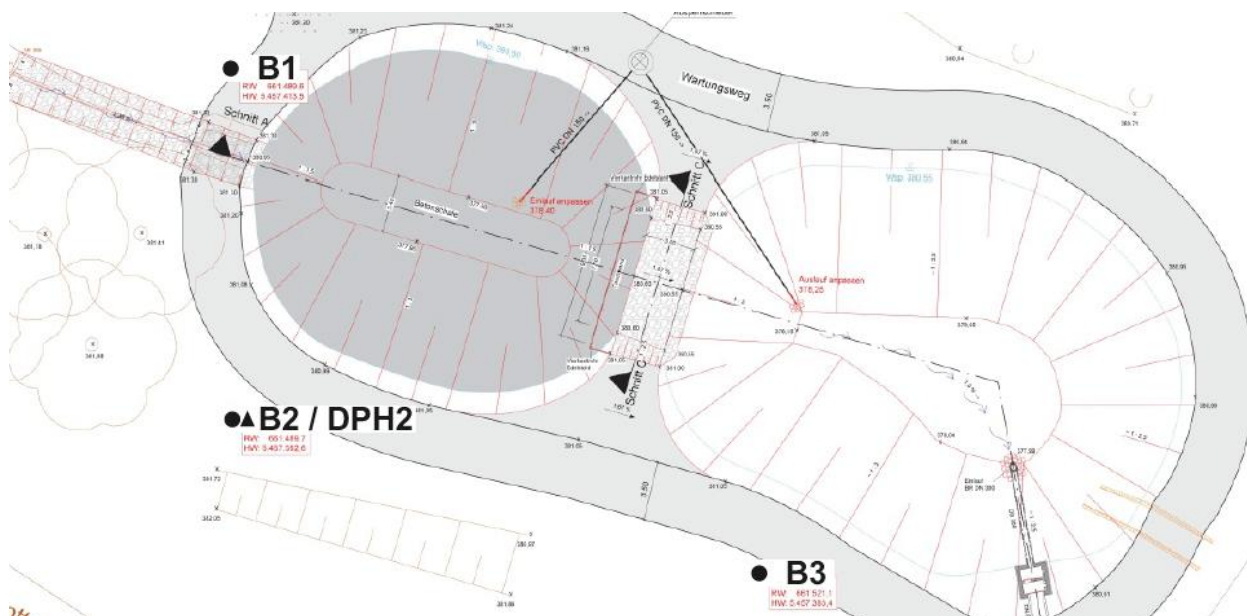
Lageplan geotechnische Untersuchungen am RRB
